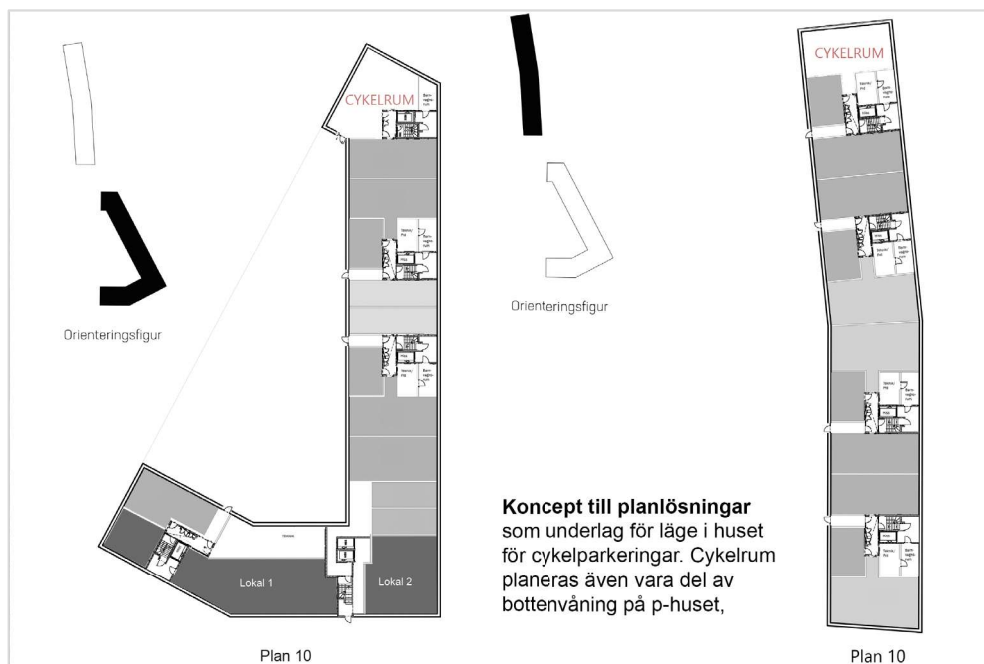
Ett cykelrum på markplan planeras i vardera bostadshus.
